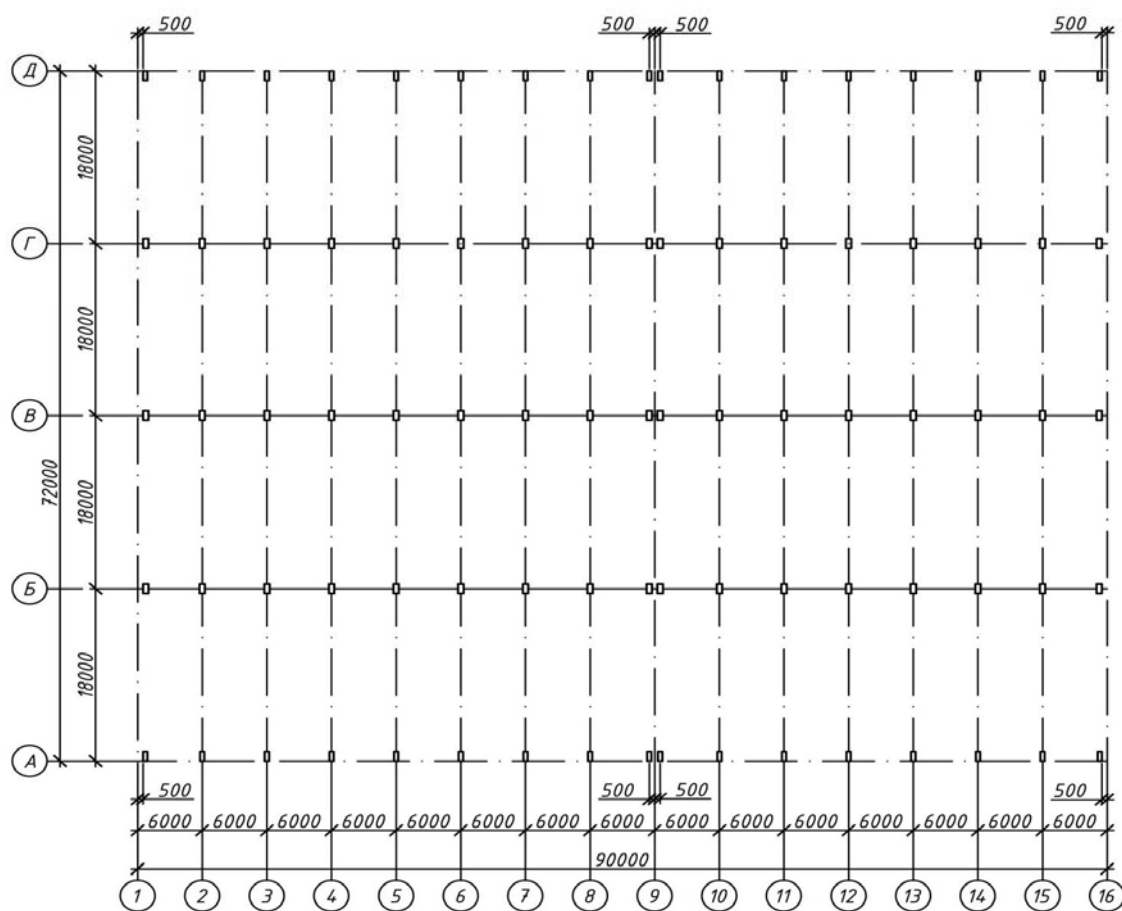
Схема здания с нулевой привязкой колонн по крайним осям
